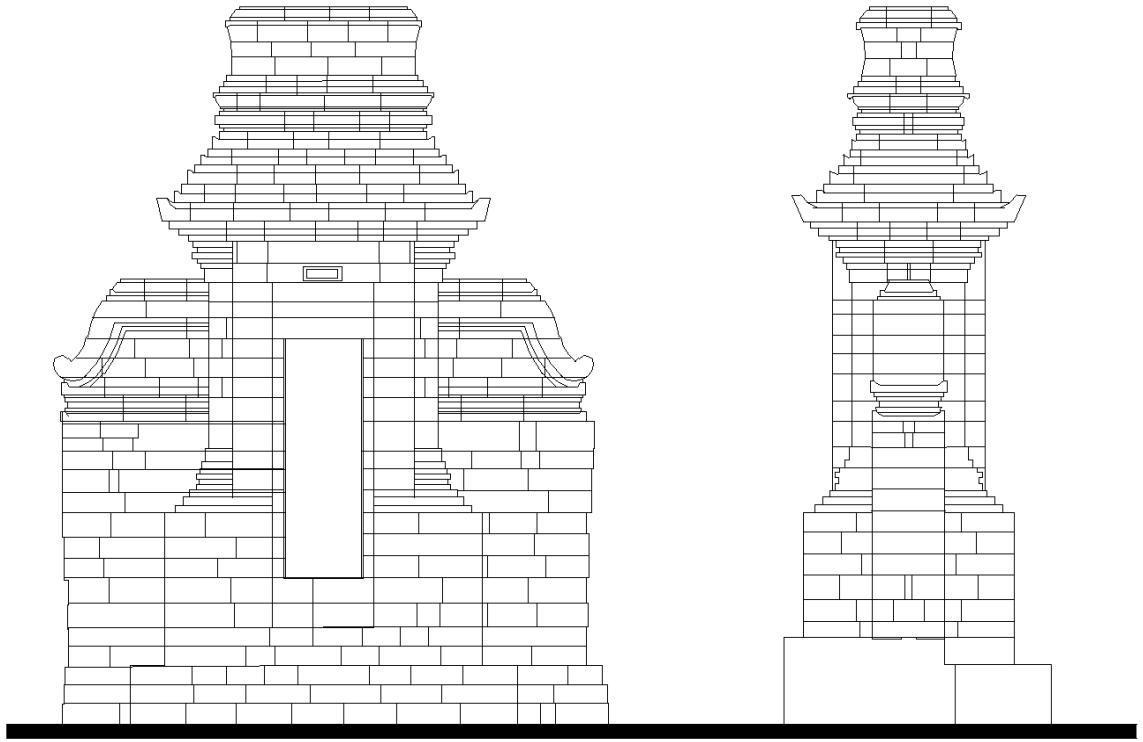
Foto tampak barat Candi Plumbangan
